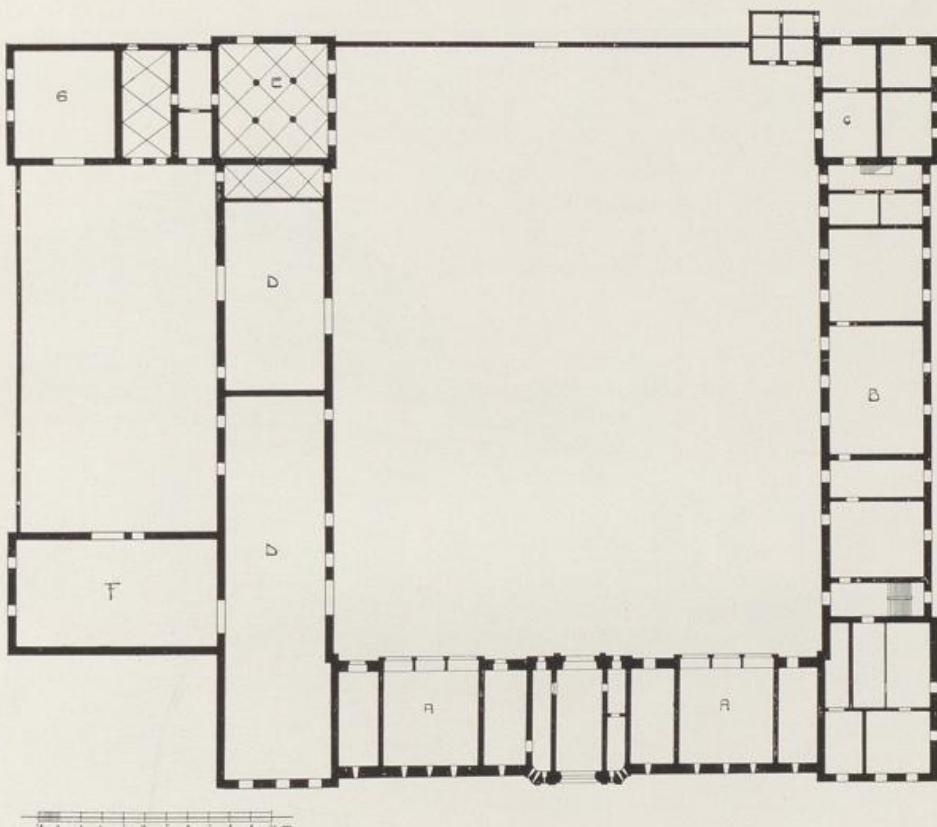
Haus Palant. Grundriss der Vorburg.
